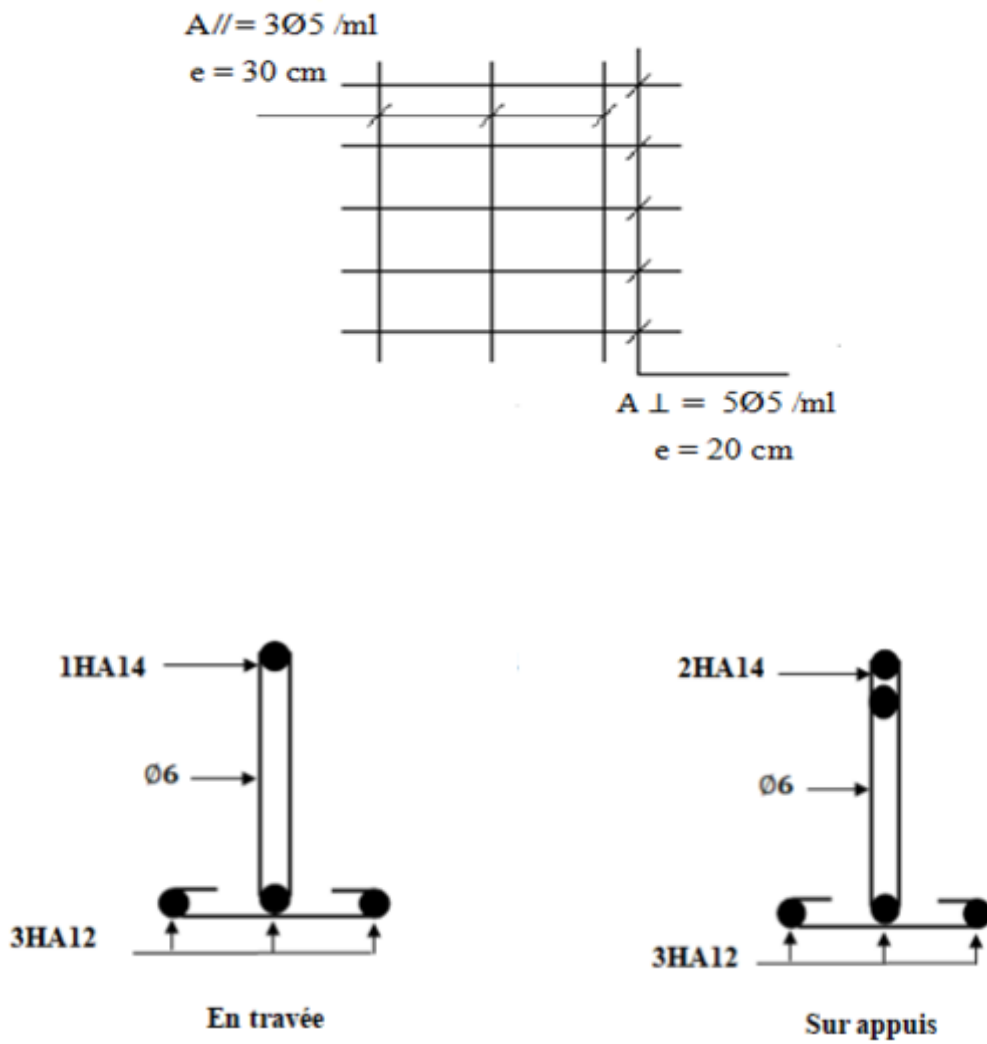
Ferrailage des poutrelles et de la dalle de compression de plancher terrasse et plancher étage courant
